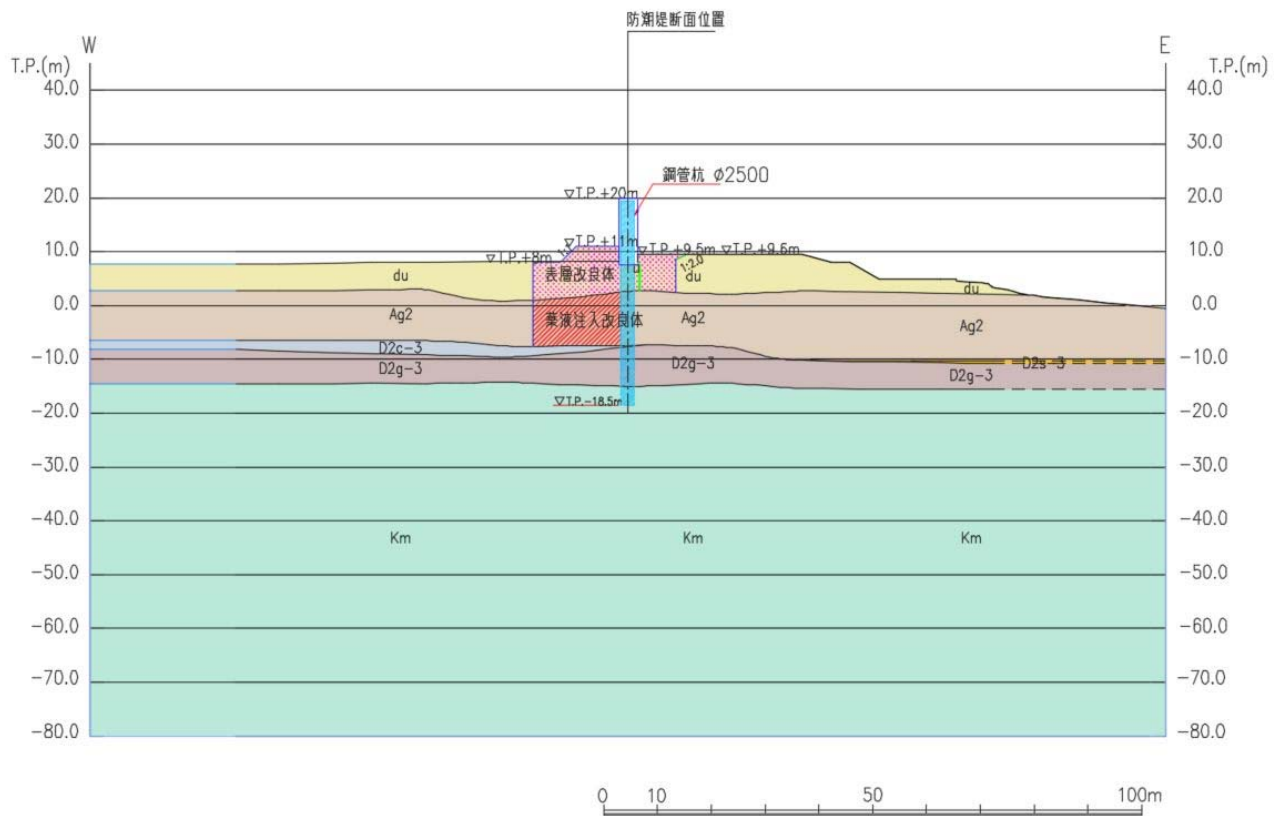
10. 5-29 (2) 鋼管杭鉄筋コンクリート防潮壁 断面図 (断面②)
